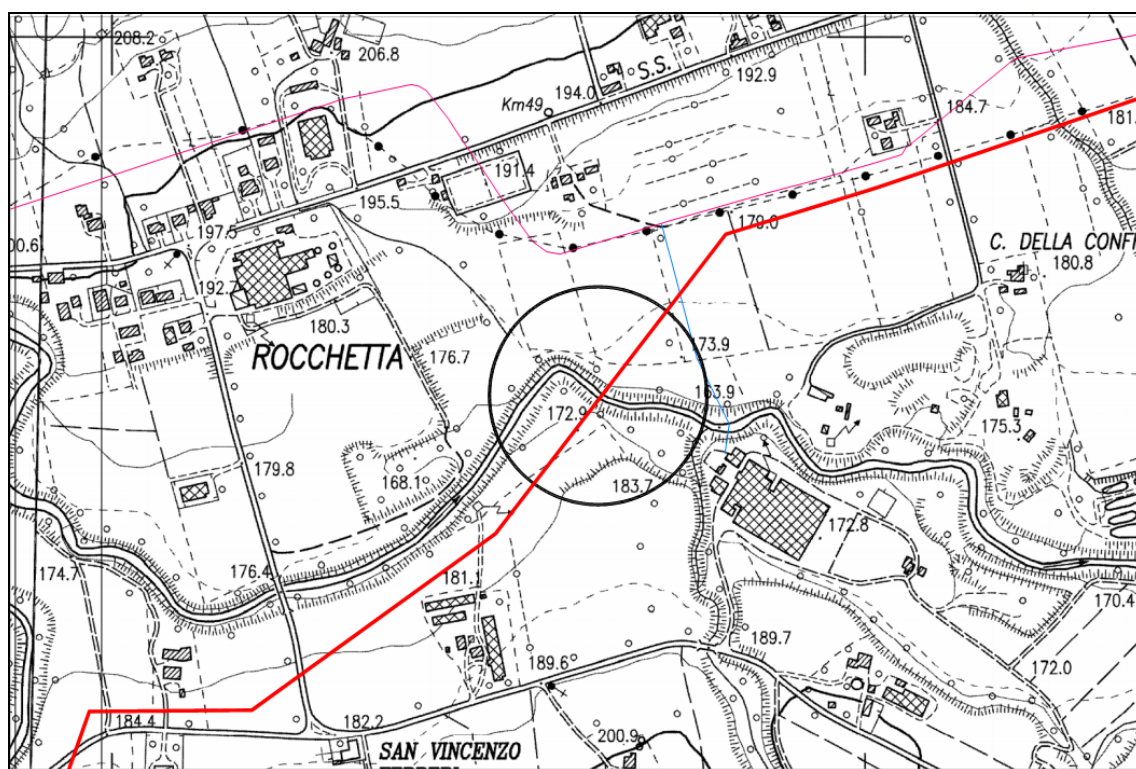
Stralcio Planimetrico in scala 1:10 000 – 1° Attraversamento
